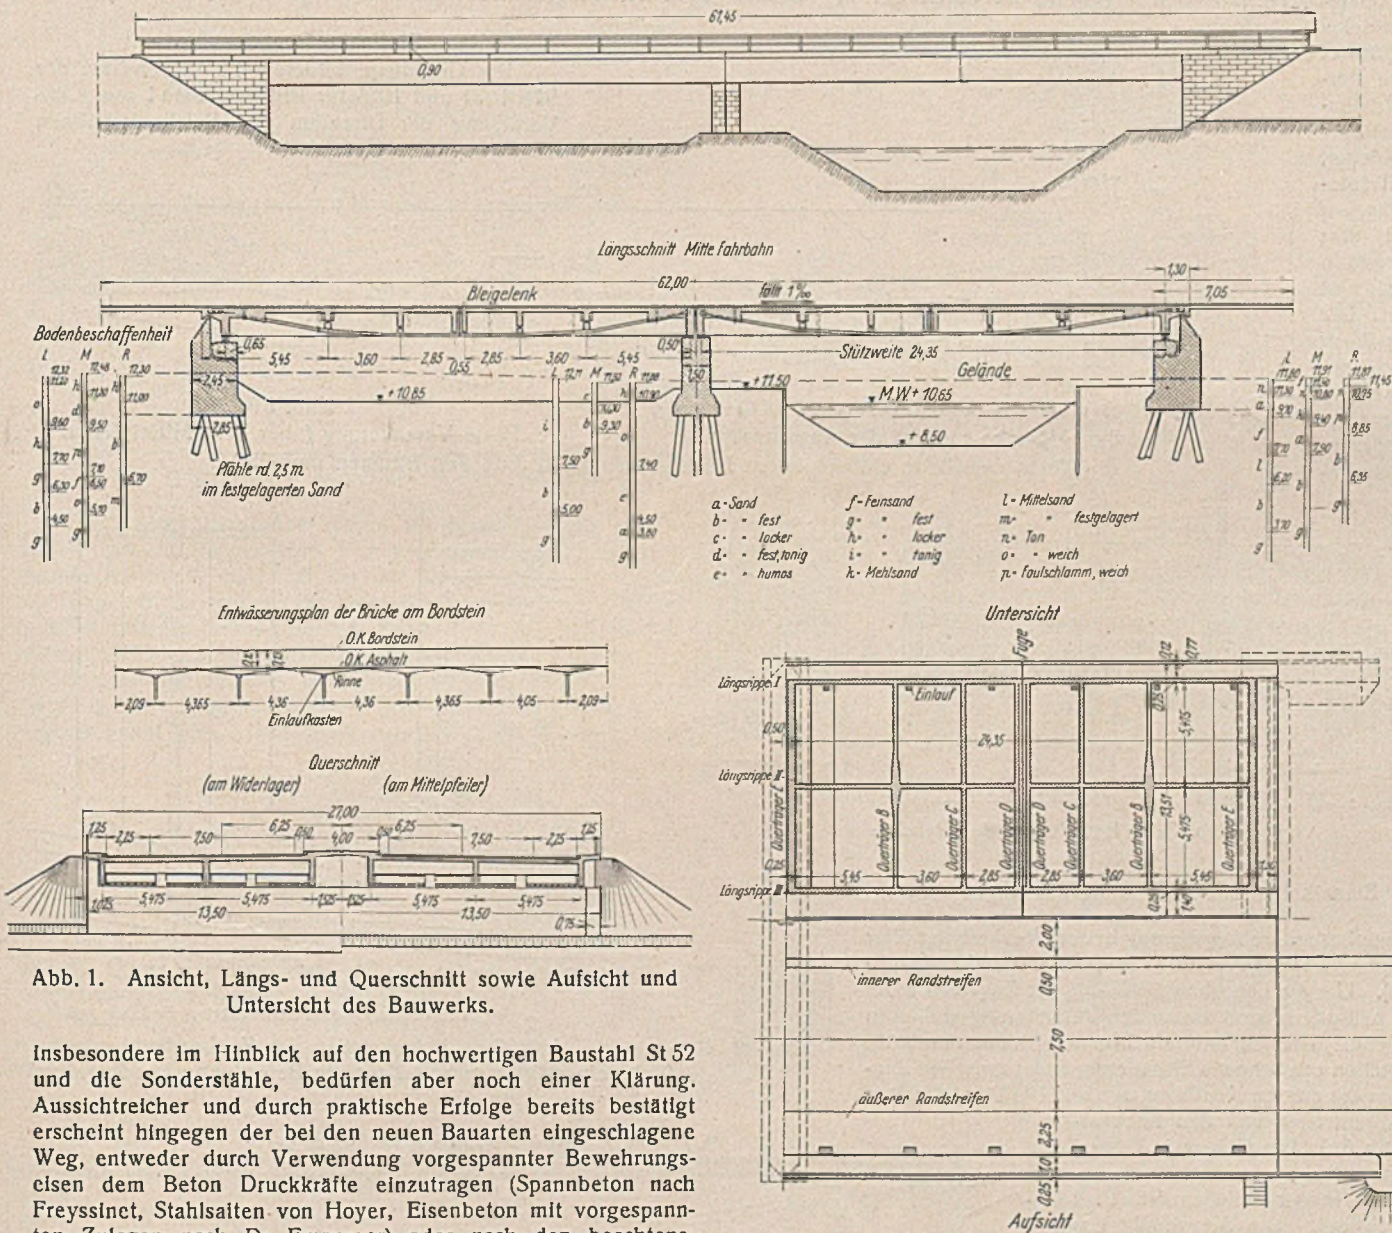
Ansicht, Längs- und Querschnitt sowie Aufsicht und Untersicht des Bauwerks.
